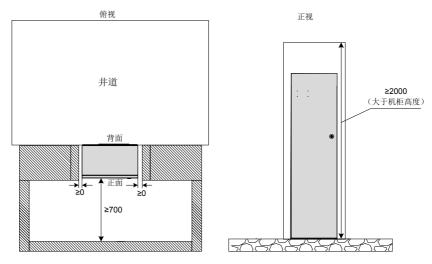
无机房控制柜安装空间要求示意图(单位: mm)
